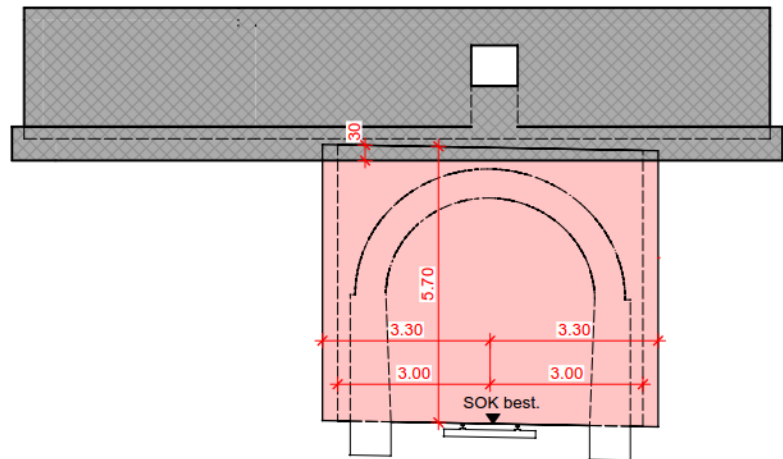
Nordfassade «Haus am Wald». Die Fassade ist praktisch direkt auf dem Mauerwerksgewölbe des Tunnels fundiert. Rot eingetragen: Vertraglich vereinbarter Interessenraum der RhB.
